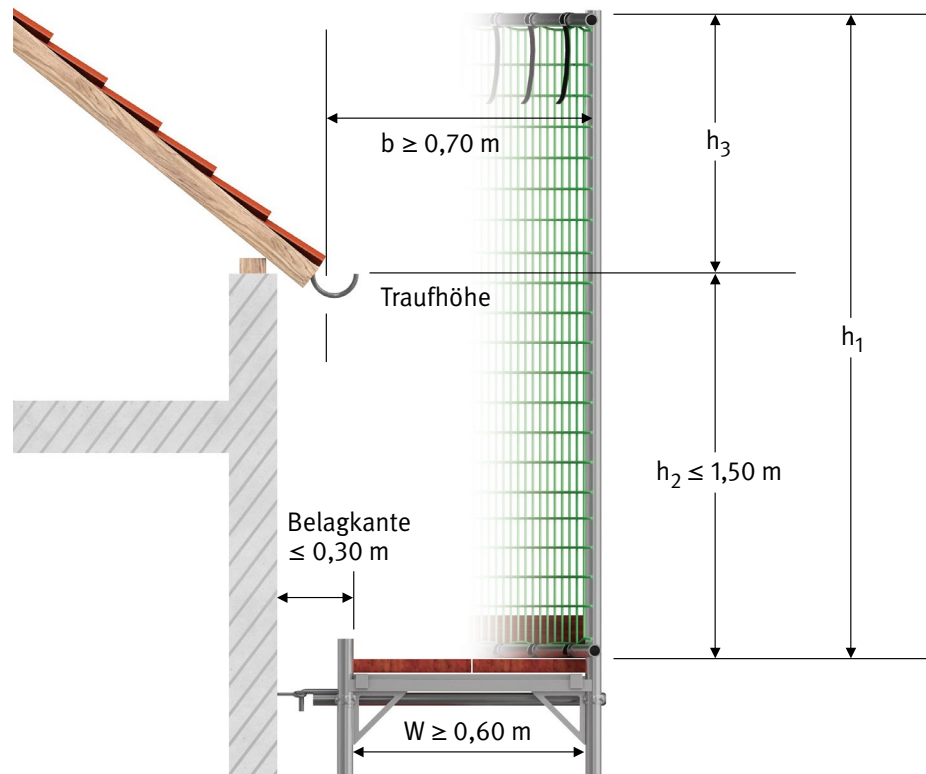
Abmessungen eines Dachfanggerüsts (Berechnung $h_3 + b \geq 1,50$ m [Maße in m])
